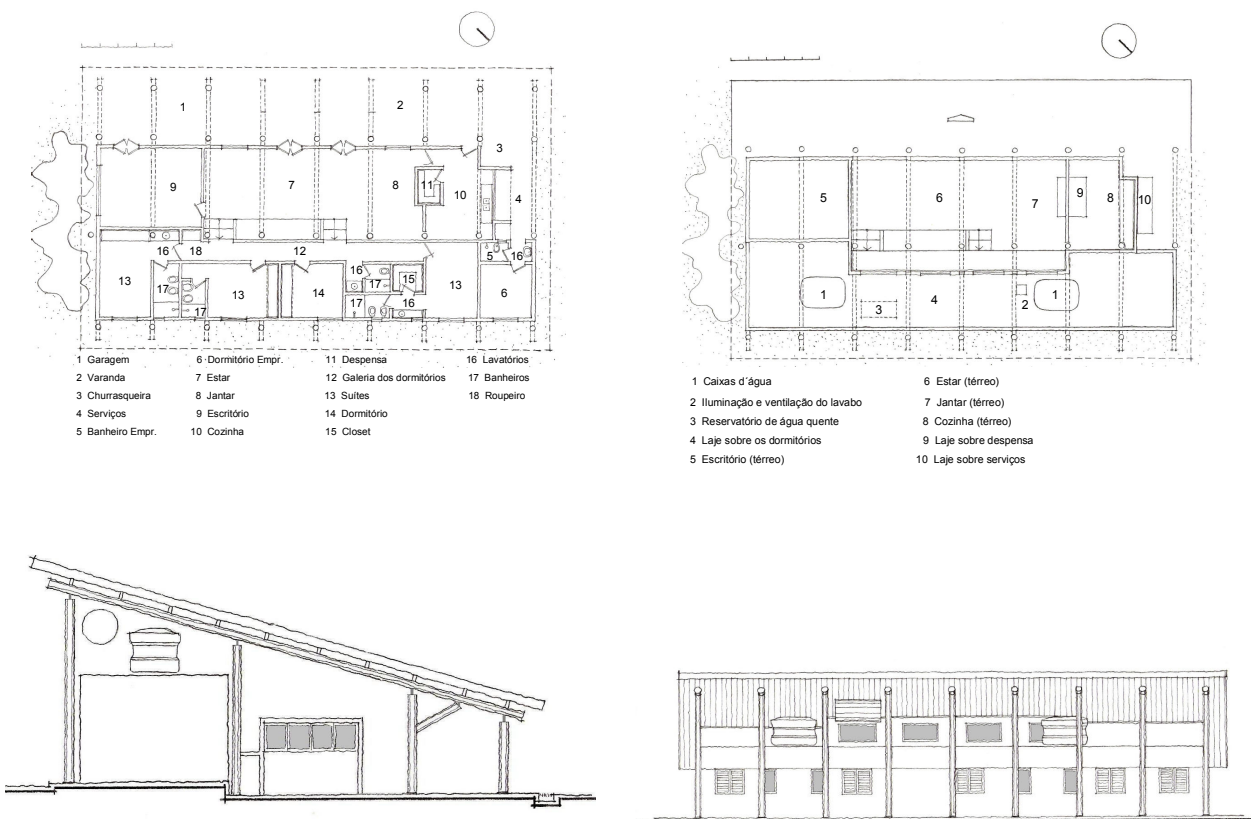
Plantas, corte e elevação – res. Wilson Cano
